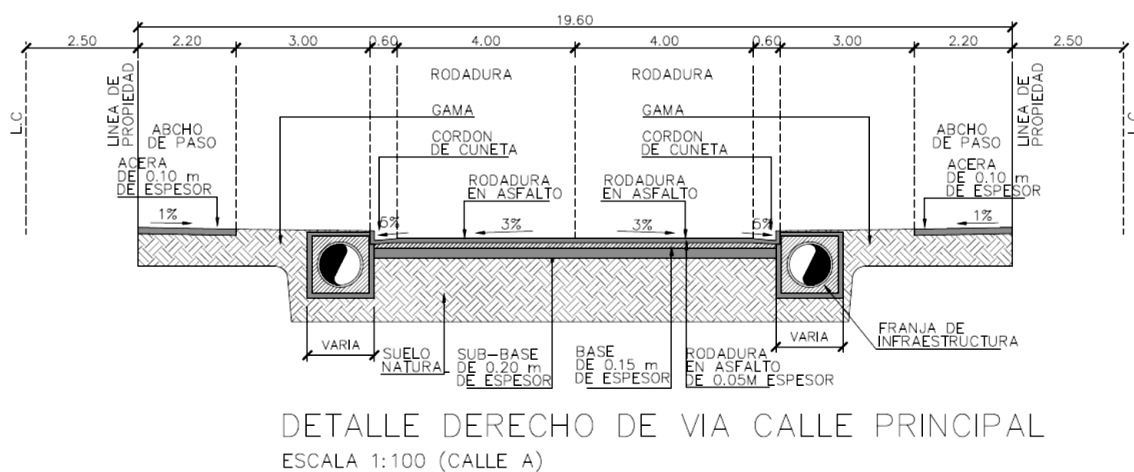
Detalle Derecho de Vía Calle Principal-Calle A
